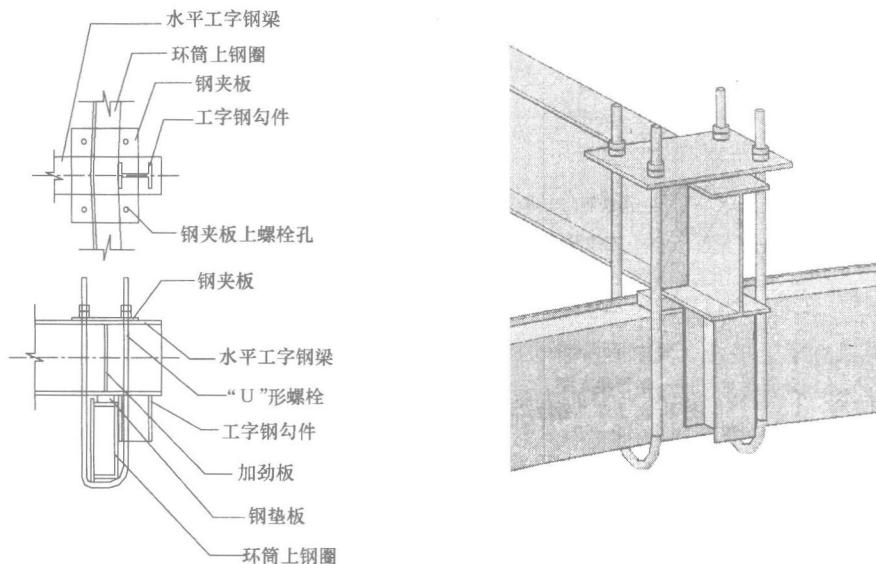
水平钢梁与中心刚性环筒连接节点构造示意
